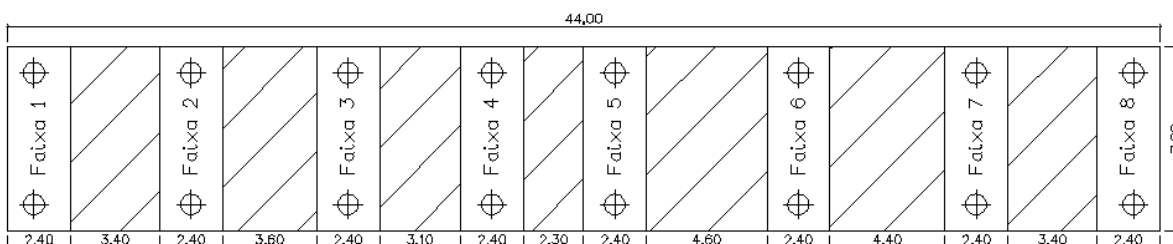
Identificação das faixas na laje de ensoleiramento – Armaduras Superiores.
